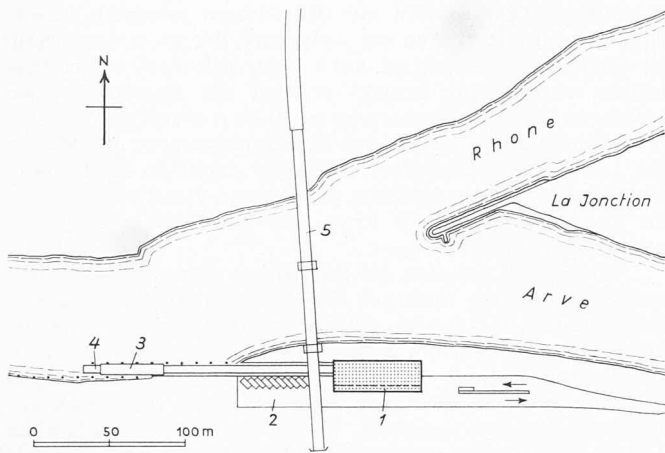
Lageplan der Verladeanlage bei La Jonction, 1:5000
